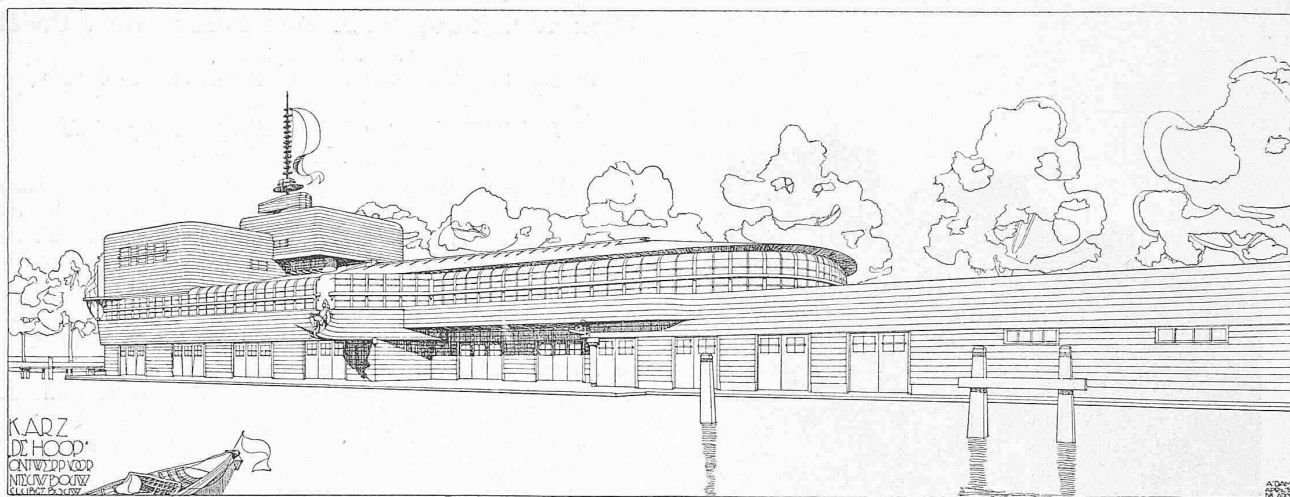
Klubhaus der Amsterdamer Ruder- und Segler-Vereinigung (Wasserseite). Architekt M. de Klerk (1922). Holzbau, unten Bootschuppen, darüber Gesellschaftsräume (vergl. Grundriss Abb. 37). Der Entwurf entfaltet sich in einer vom Innern ausgehenden, das ganze Gebäude umspielenden und jede Einzelheit mitreisenden Bewegung, die sich der Anknüpfung der Boote entgegenstellt.
